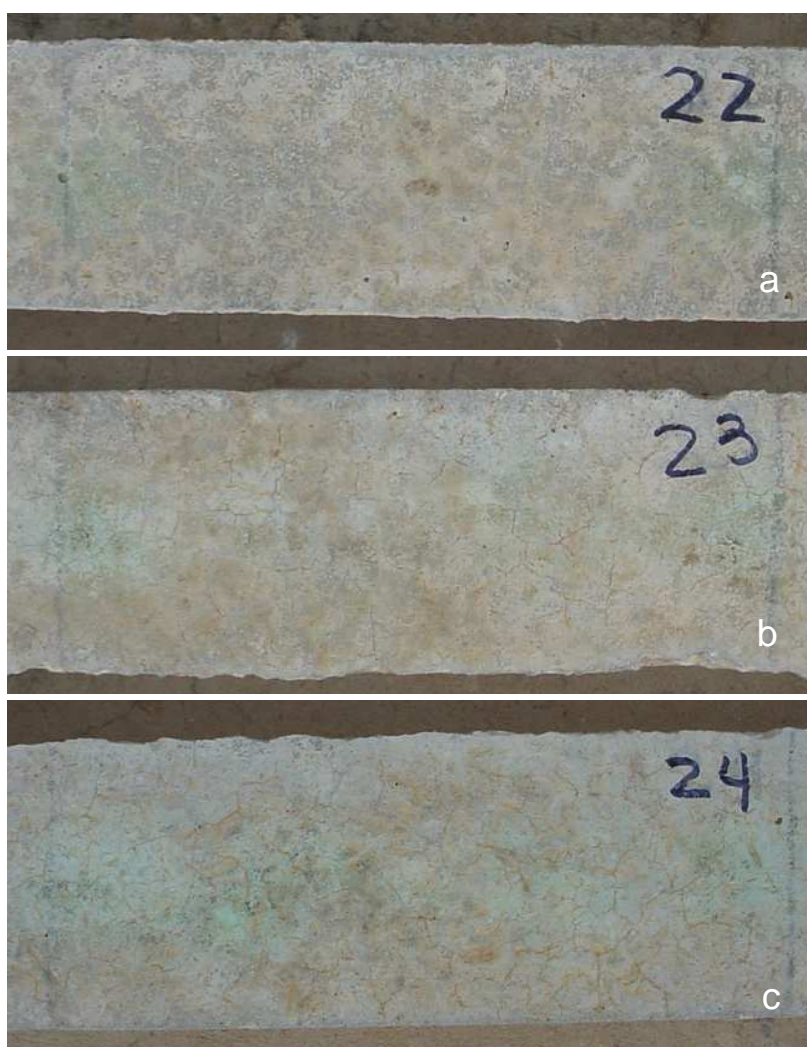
Fisuras observadas en vigas sin precarga.
